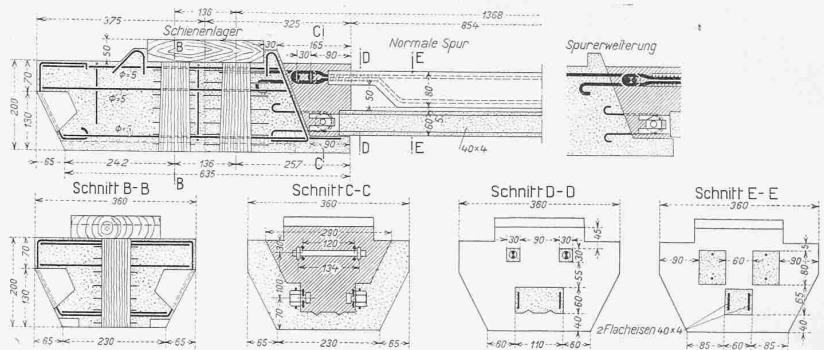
Längsschnitt und Querschnitte durch die Eisenbeton-Schwelle. — Masstab 1:15.
